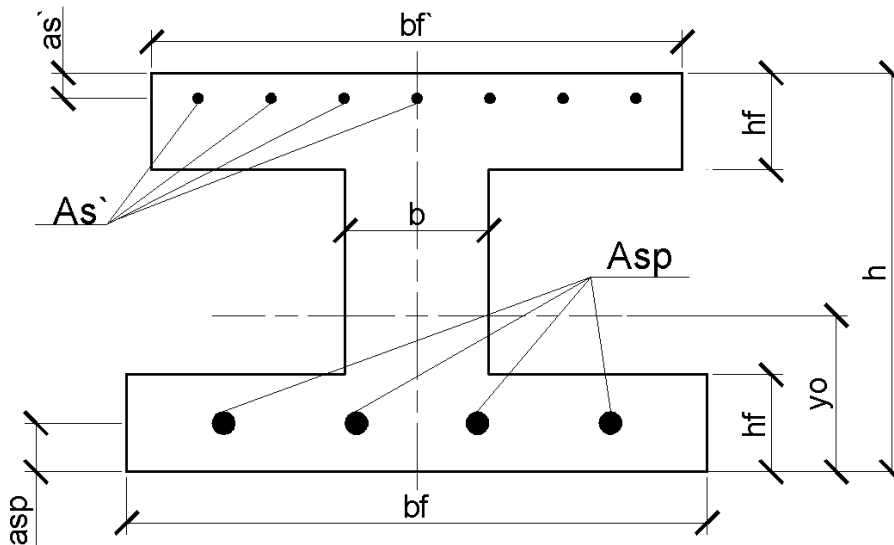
Схема розташування арматури в перерізі плити
